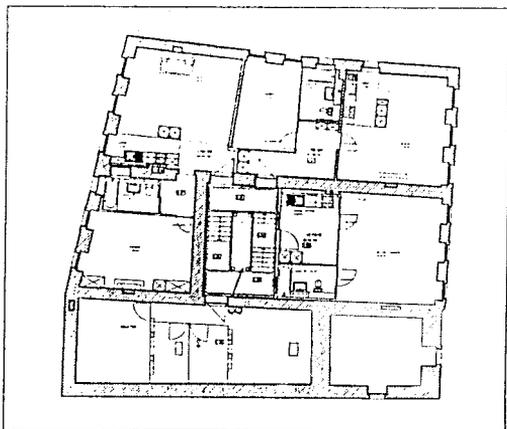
plan du 1er étage, transformé, dessin atelier d'architecture Arielle Denoréaz
